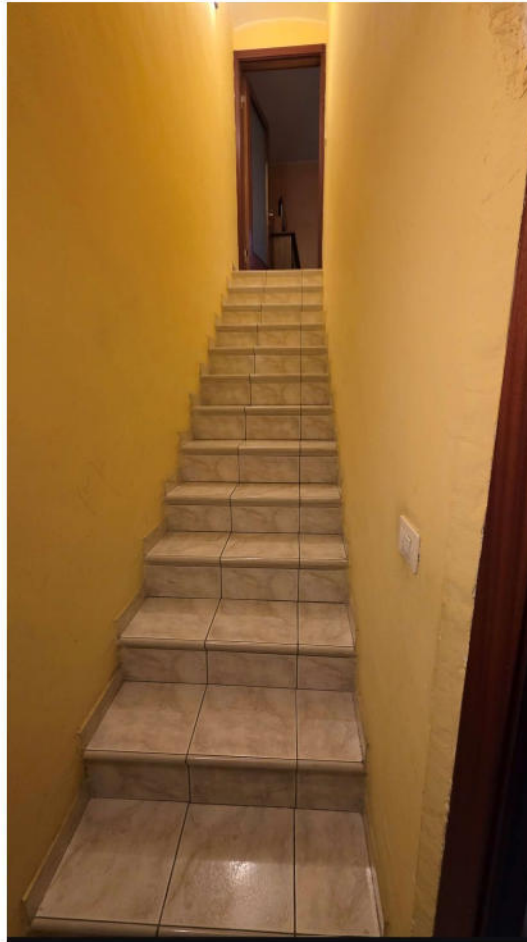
piano terra, vano scala di collegamento tra il P.T. e il P.1
